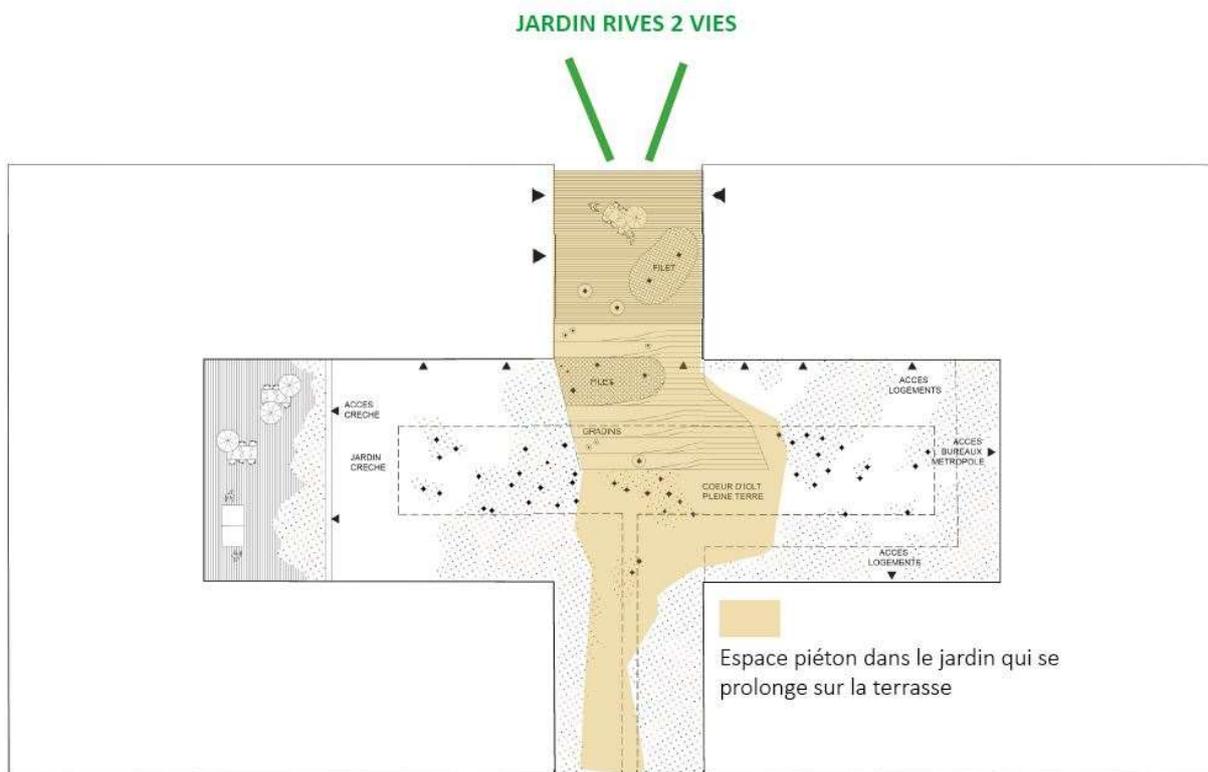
la poursuite du paysage entre le jardin et la terrasse (A+R paysage, 2020)
